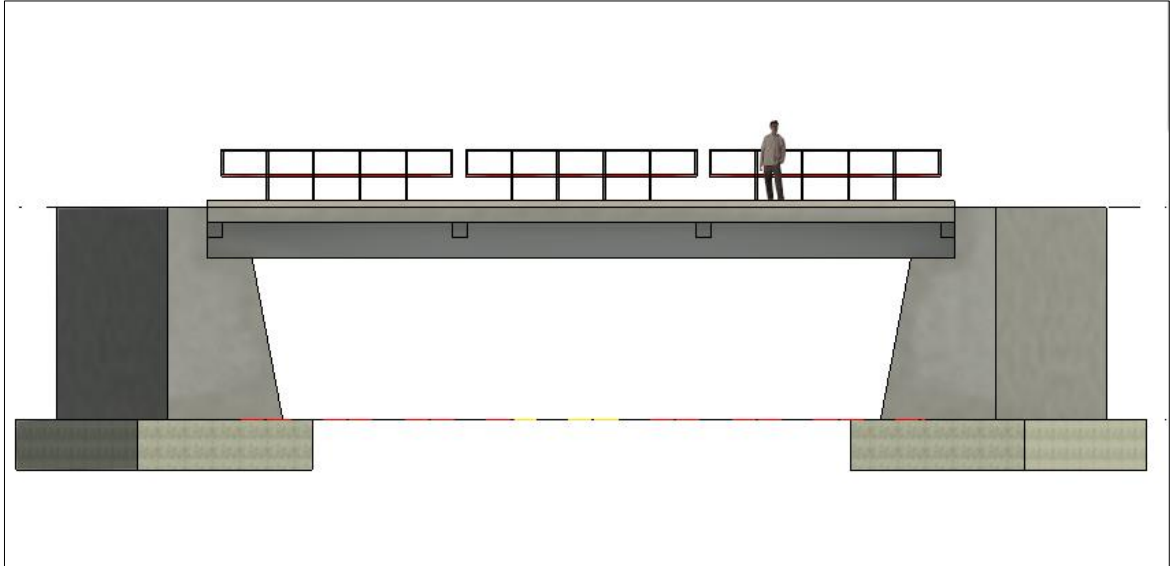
Modelado en Revit 2023, vista en sección longitudinal del puente San Martín.
